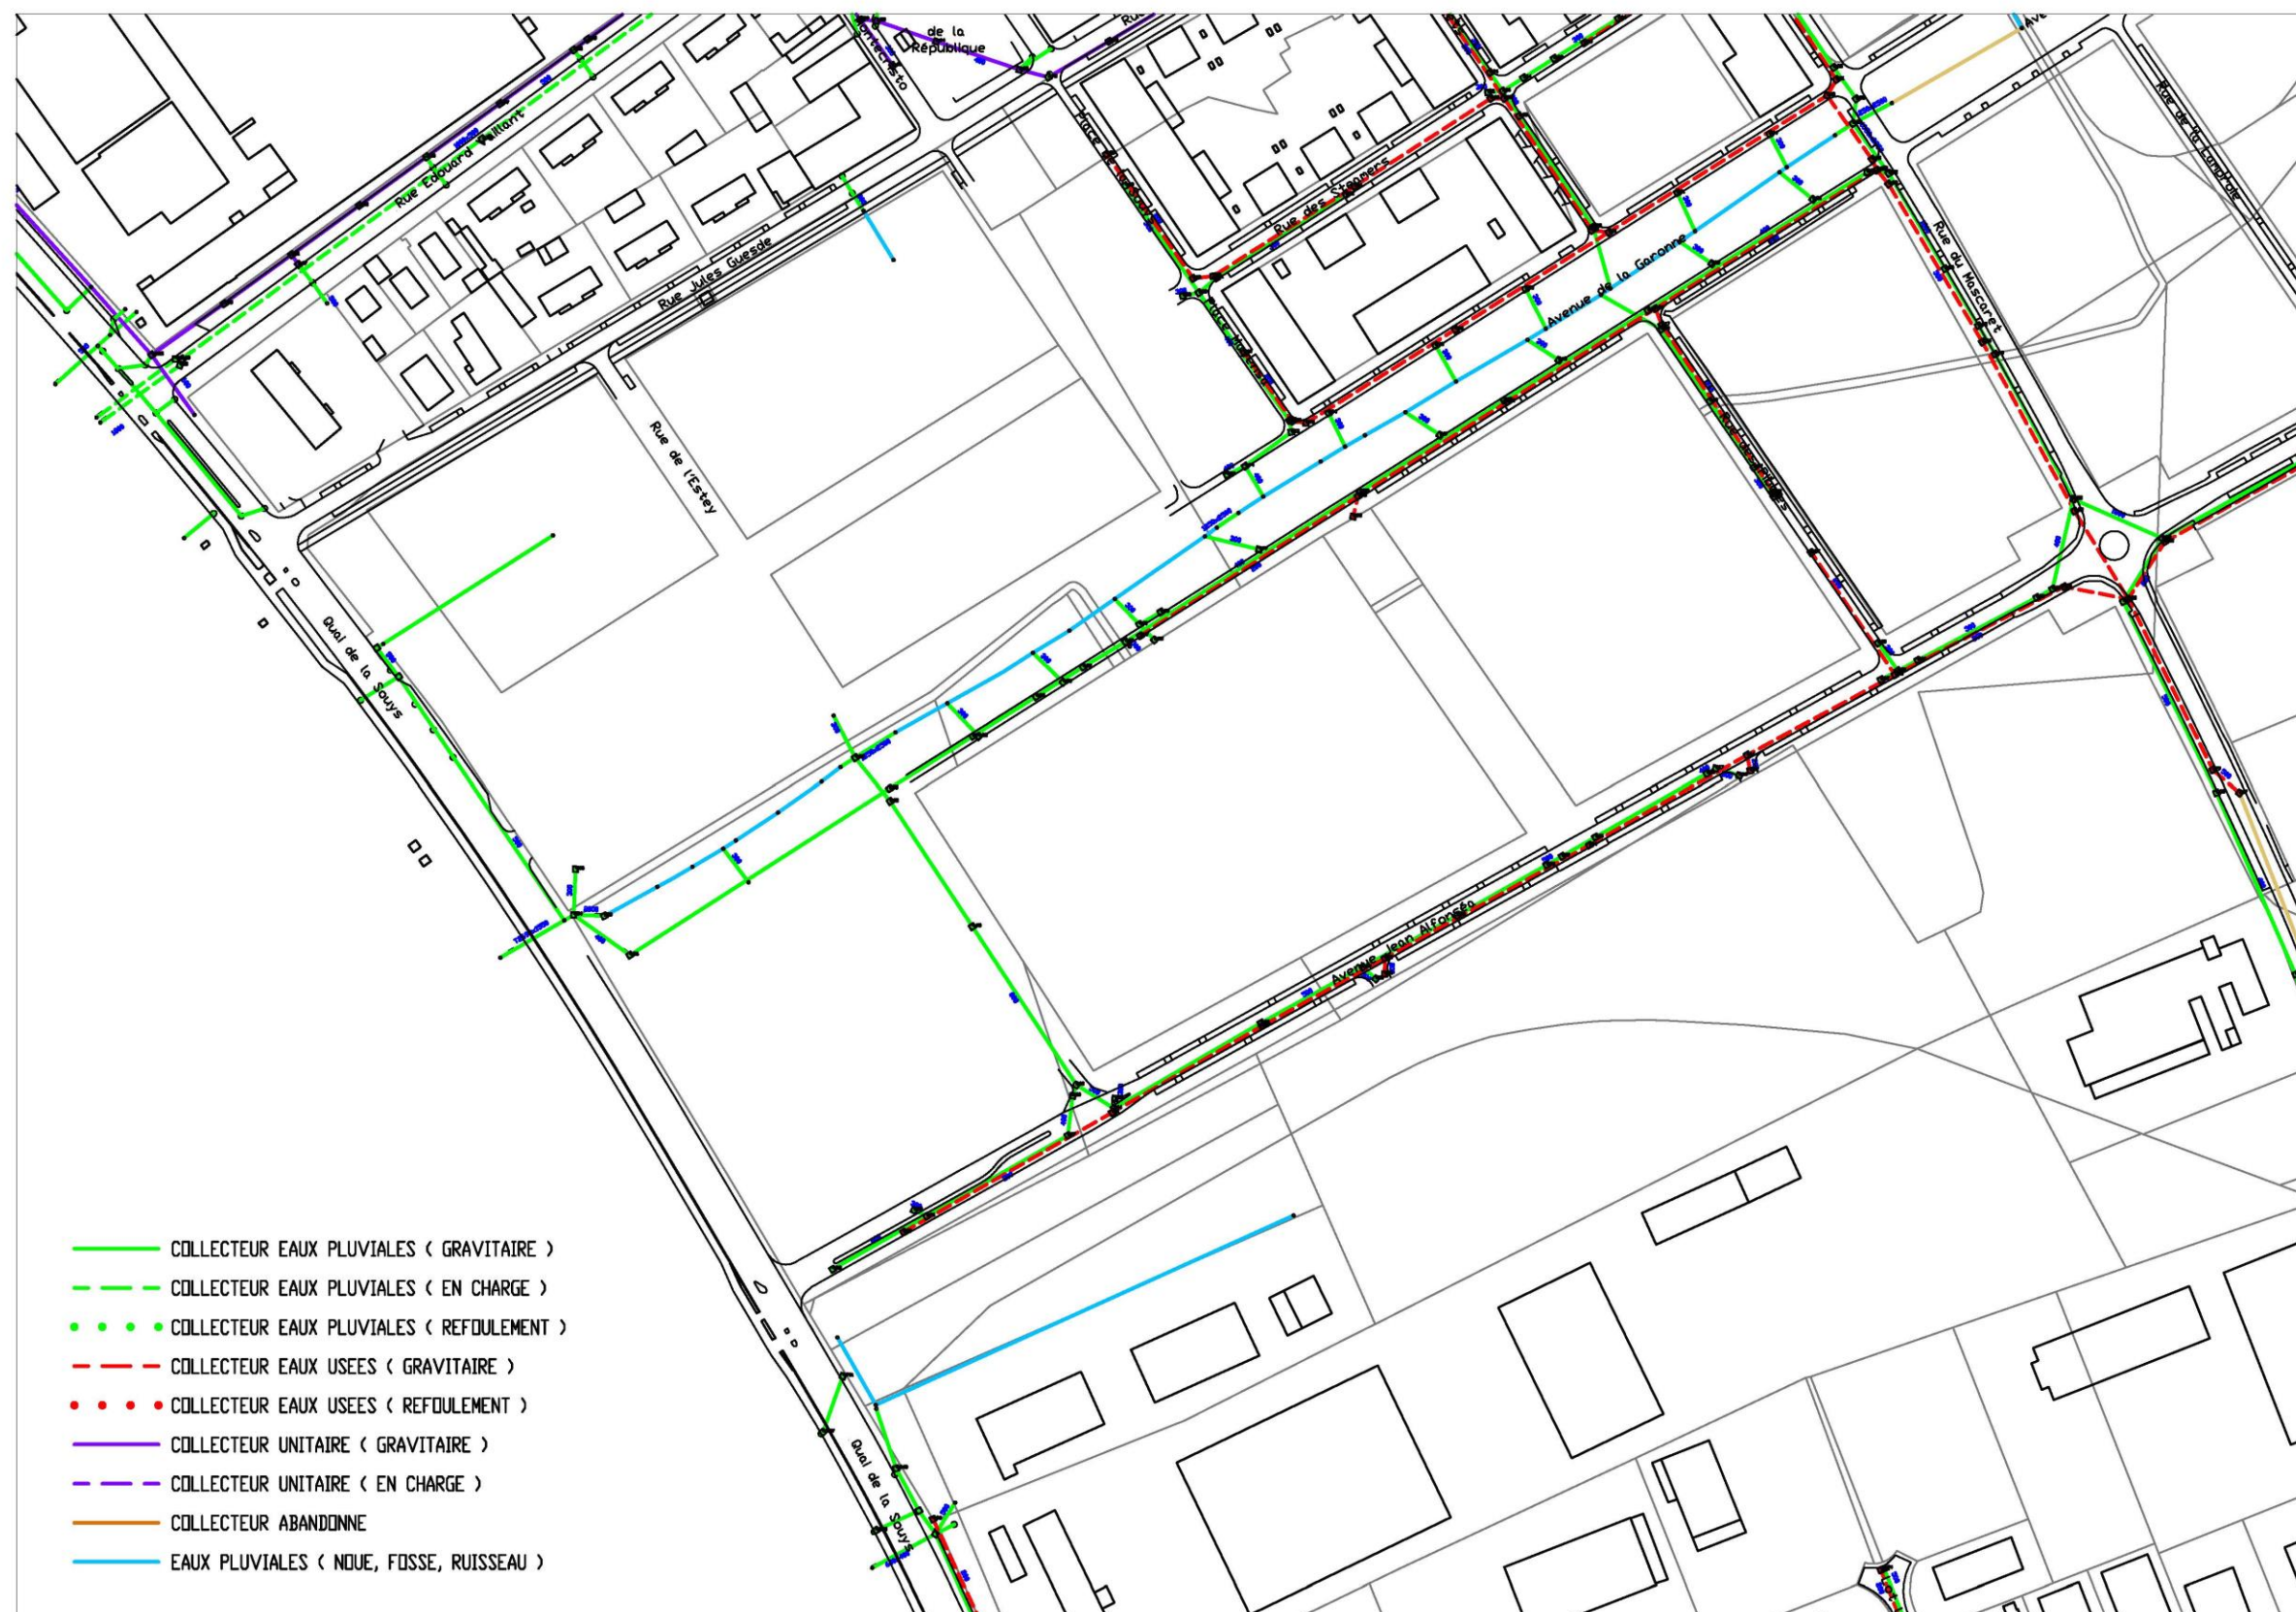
Plan des réseaux d'assainissement communautaire, rive gauche, planche 1
